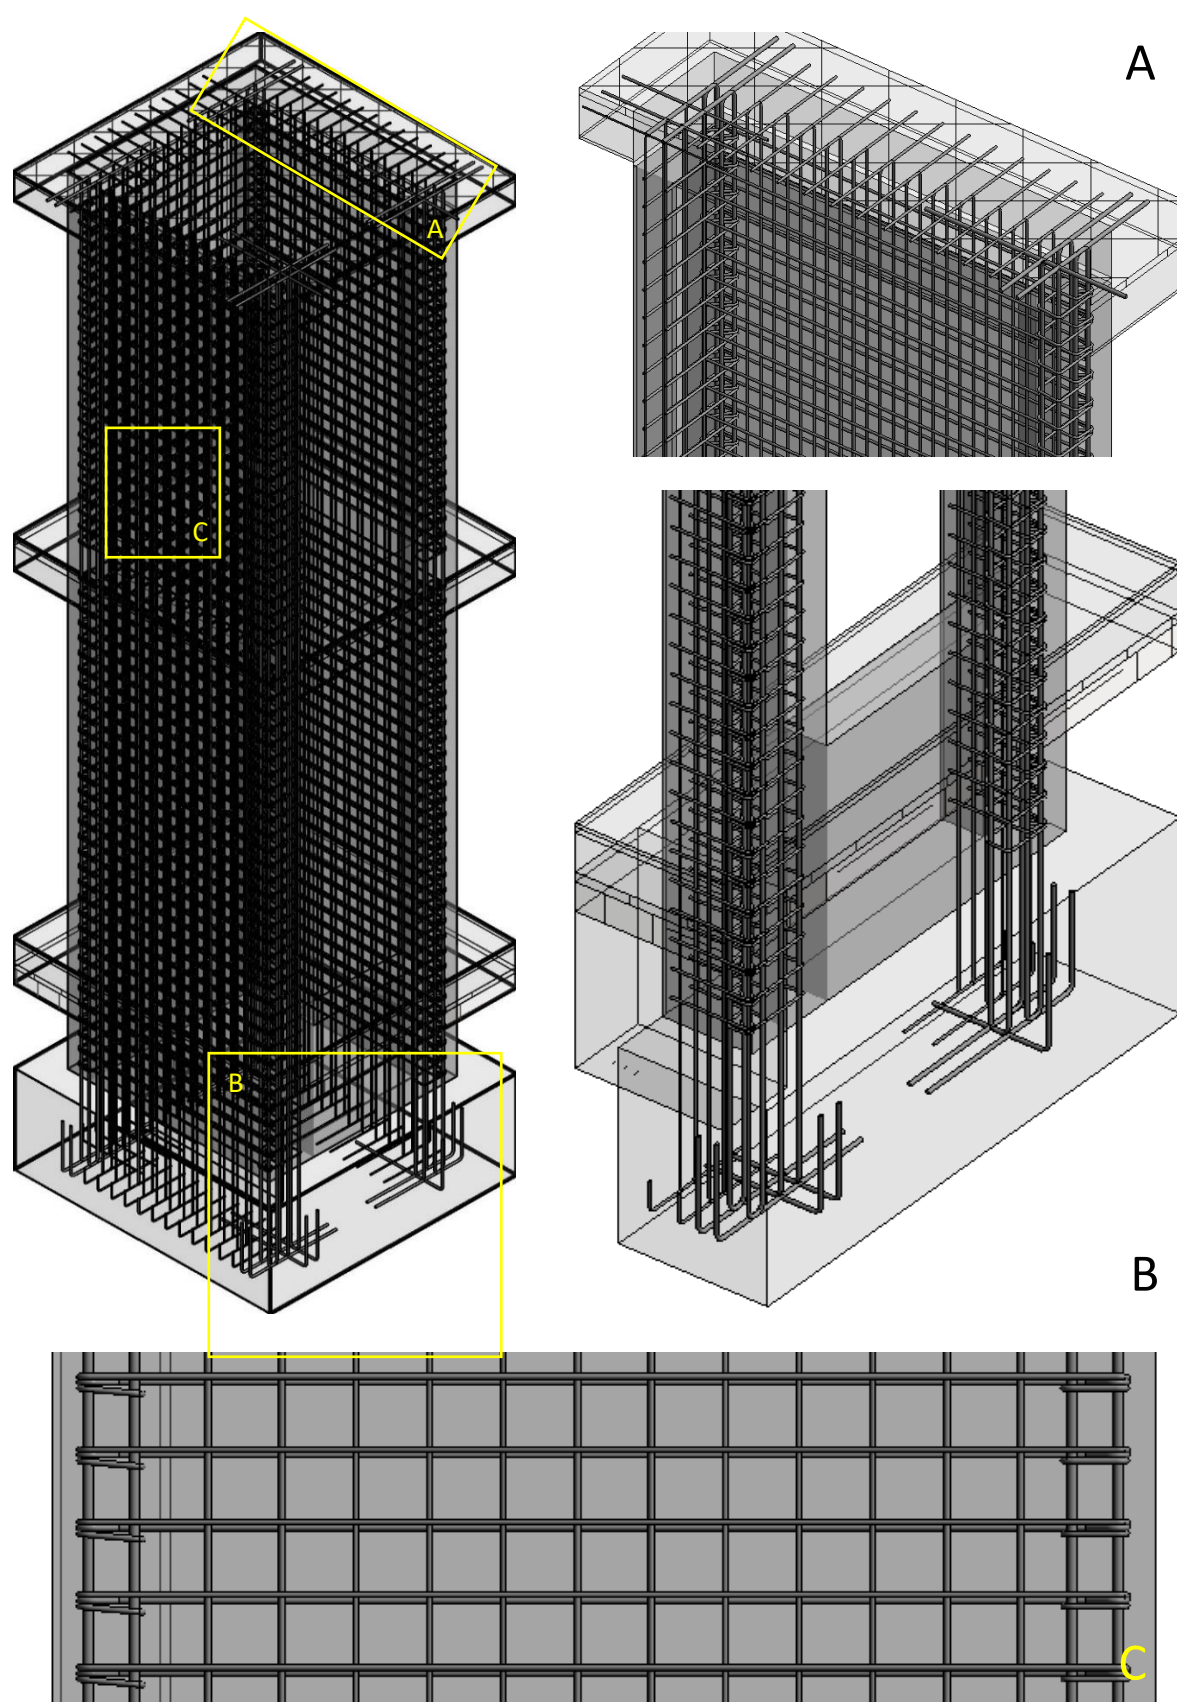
Modelos 3D de armaduras – Caixa de Elevadores do edifício administrativo
